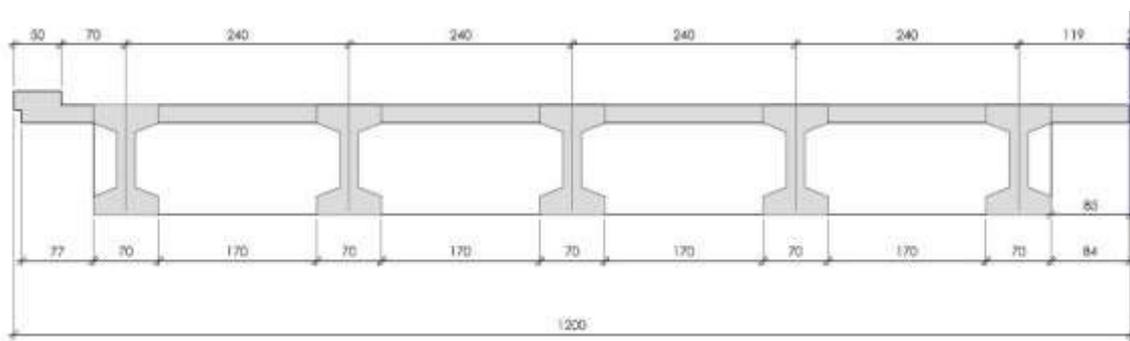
Sezione trasversale in retto di $\frac{1}{2}$ dell'impalcato (mezzeria)
